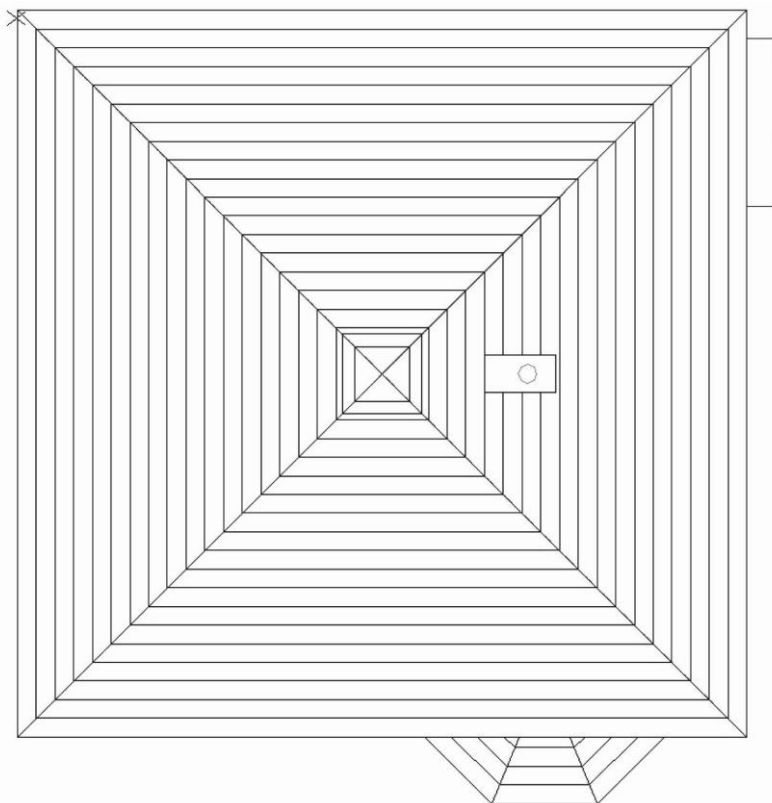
Planta alta da cobertura. Fonte: Defferrari (1999)
